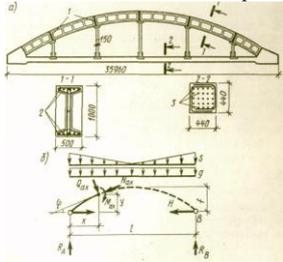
Конструкция сборной арки покрытия (а) и расчетная схема (б):
